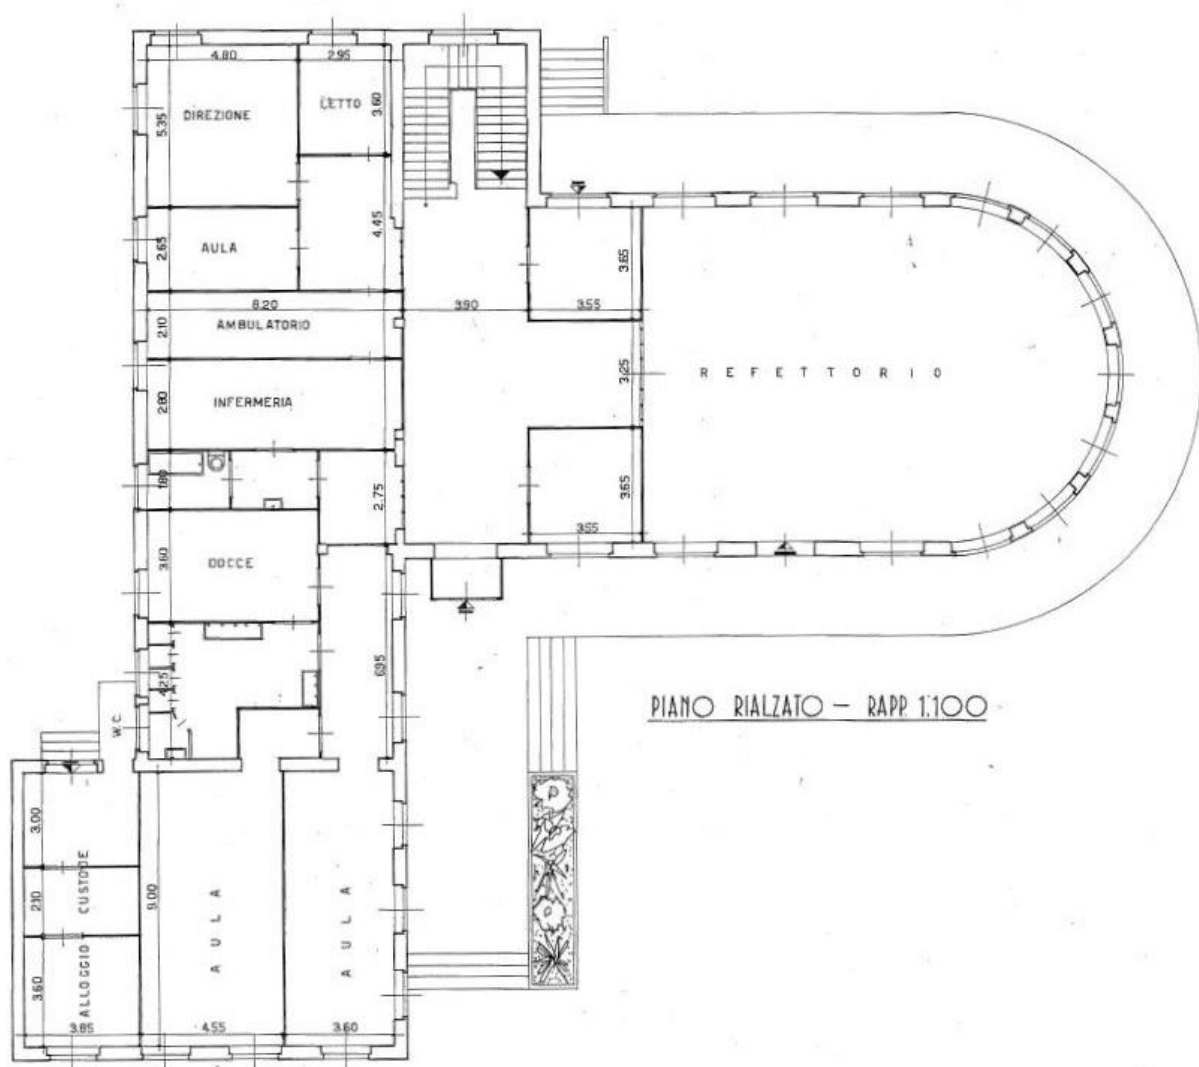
Pianta piano rialzato, seconda versione di progetto
